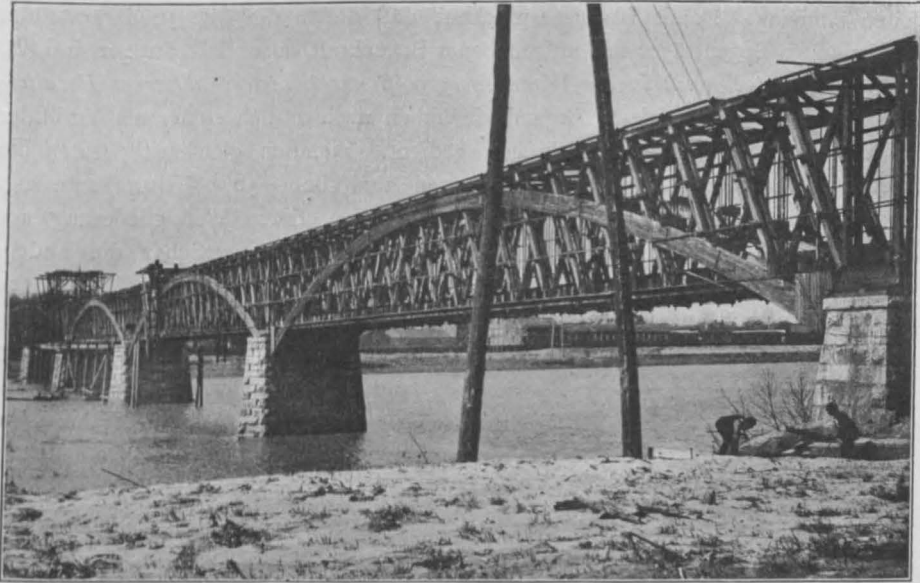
Alte Holzbrücke über den Savannahfluß bei Augusta, Georgia. Bauart BURR.
